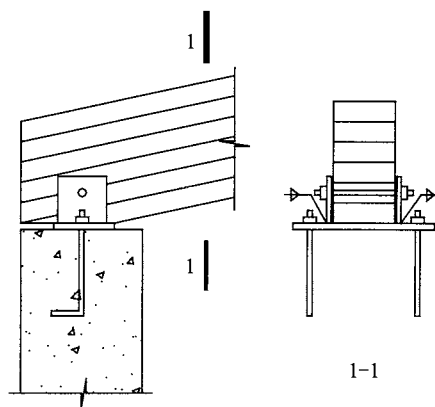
斜木梁与混凝土基础或砖基础连接节点示意
